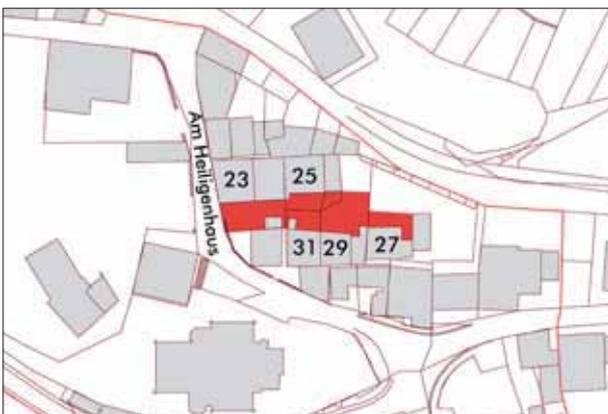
Lageplan Am Heiligenhaus 23 - 31
